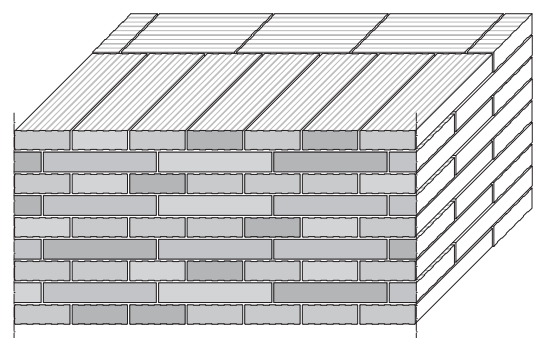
Esquema de aparejo inglés en muro de 1'5 pies.
